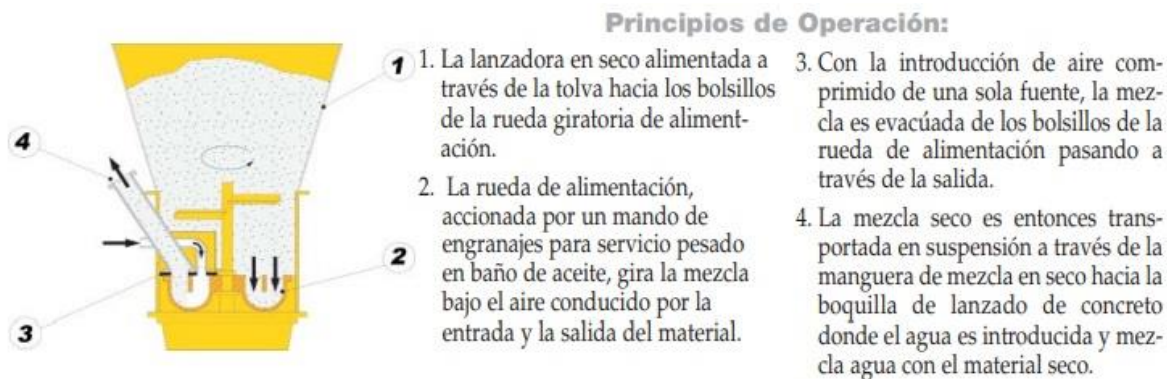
Operación máquina de rotor para proyección seca de concreto.⁷⁵
